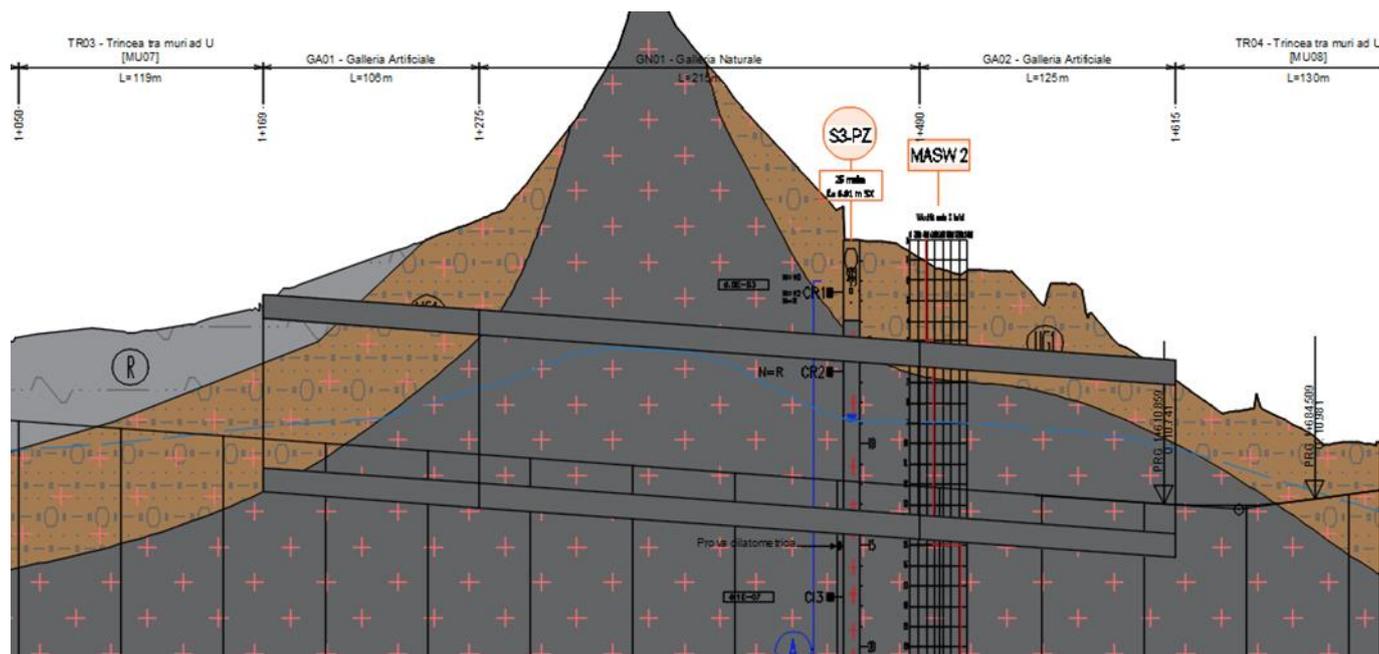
Stralcio del profilo Geotecnico alle pk di interesse
